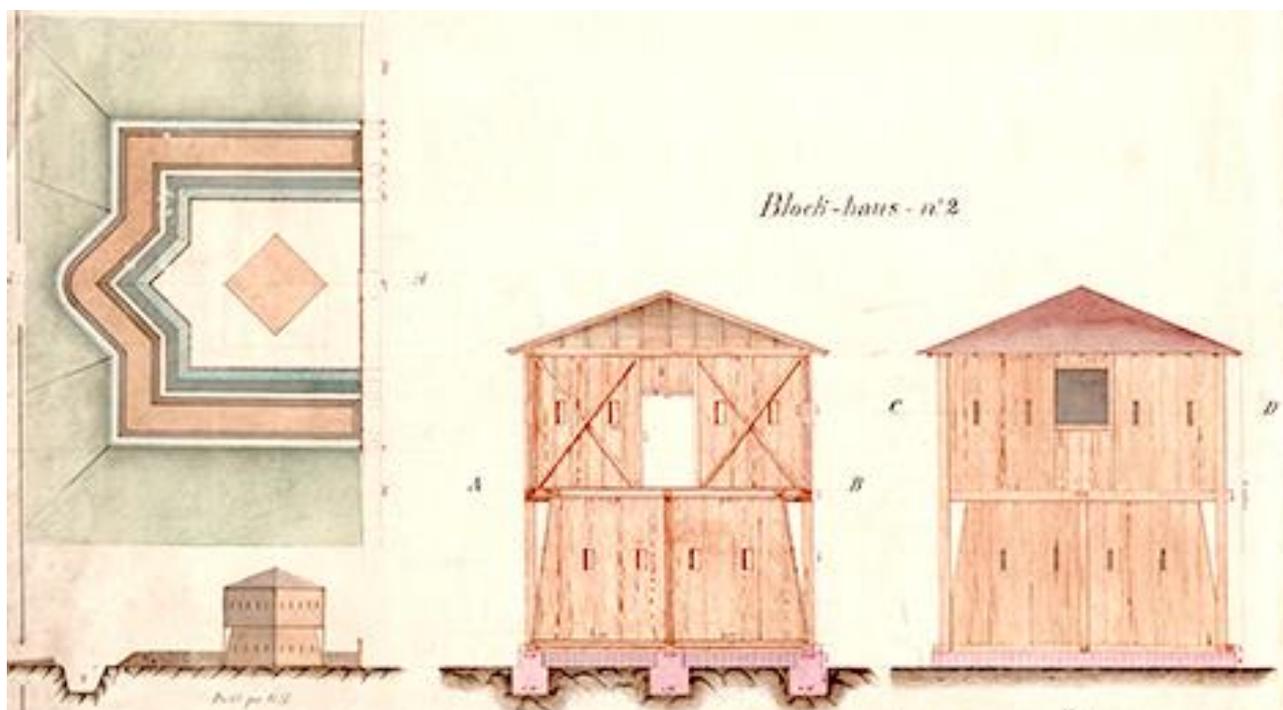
Block-haus de madera para cubrir la entrada del camino de la isla por el río Yarayó, dibujado por Antonio Planas en abril de 1874. Presenta el plano de la planta del blocao y un perfil longitudinal del mismo (España, MinisDef, AGMM detalle BVD, CUB-100\_08)
